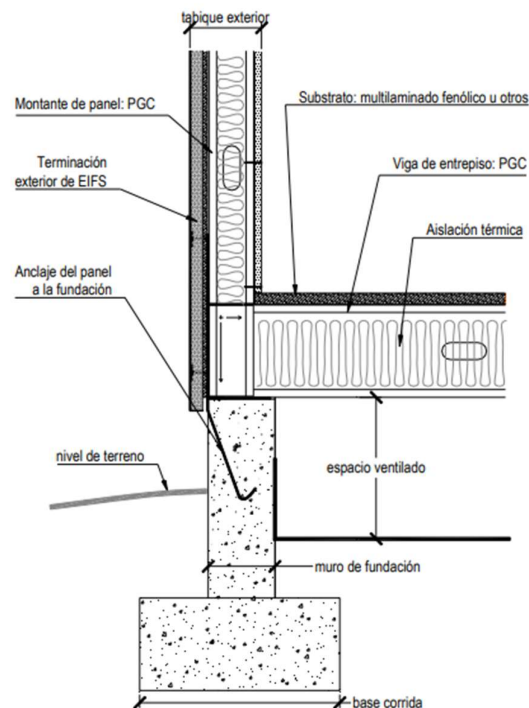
| Fundaciones en construcciones de steel frame de zapatas o muros corridos. Fuente: Manual de Procedimiento – Consul Steel.
